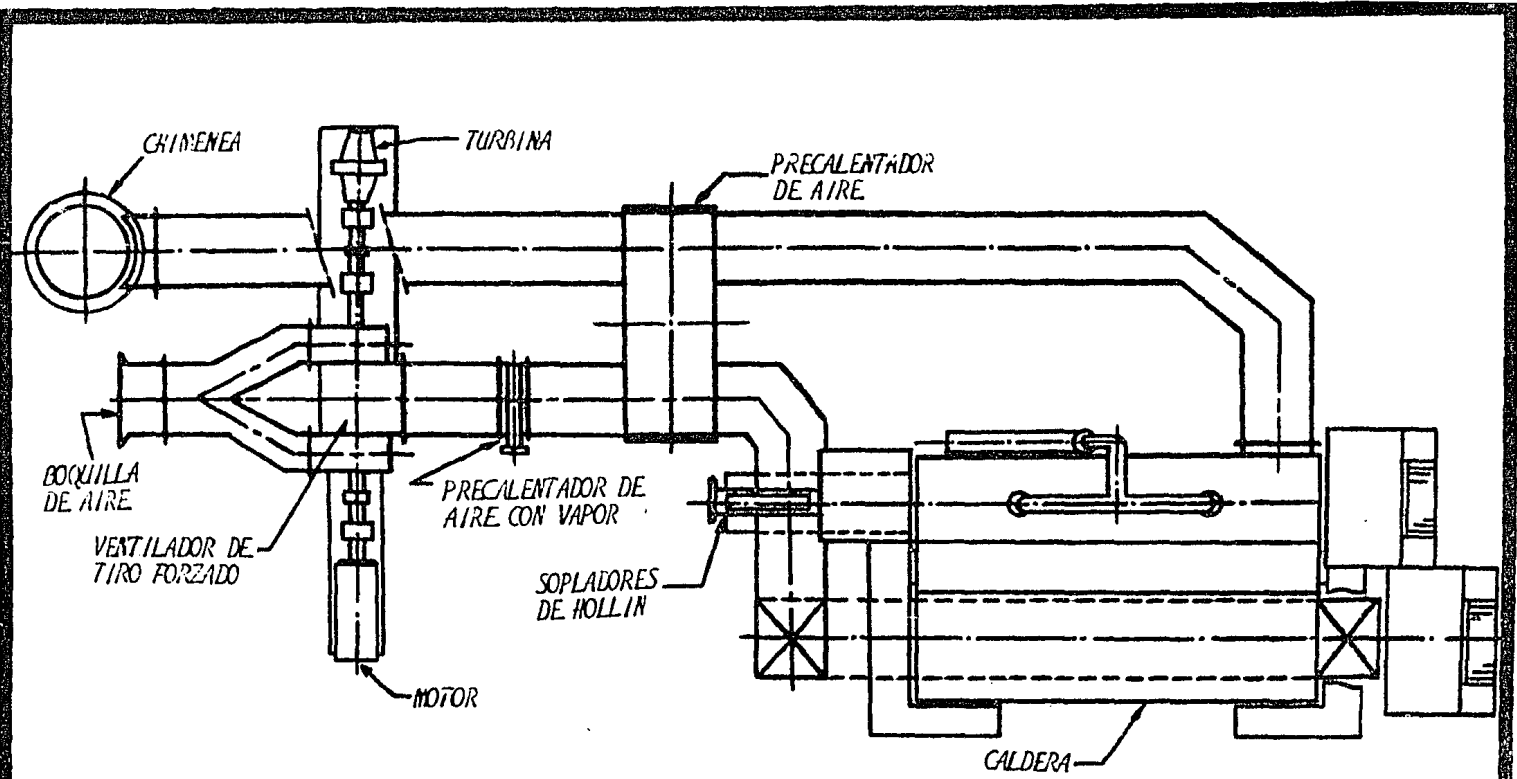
GENERADOR DE VAPOR VISTA DE PLANTA .
